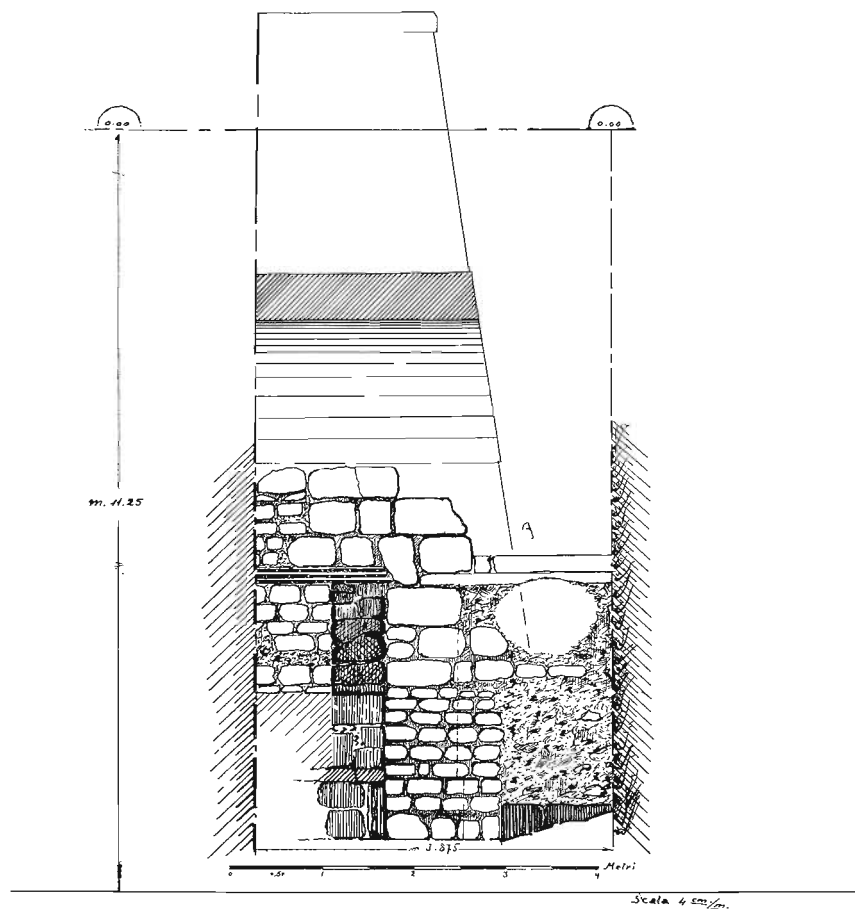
ROVINE DI VIA EL BARDESSI (LATO OVEST DEL MURO 3 E SEZIONE DEL MURO 4).
